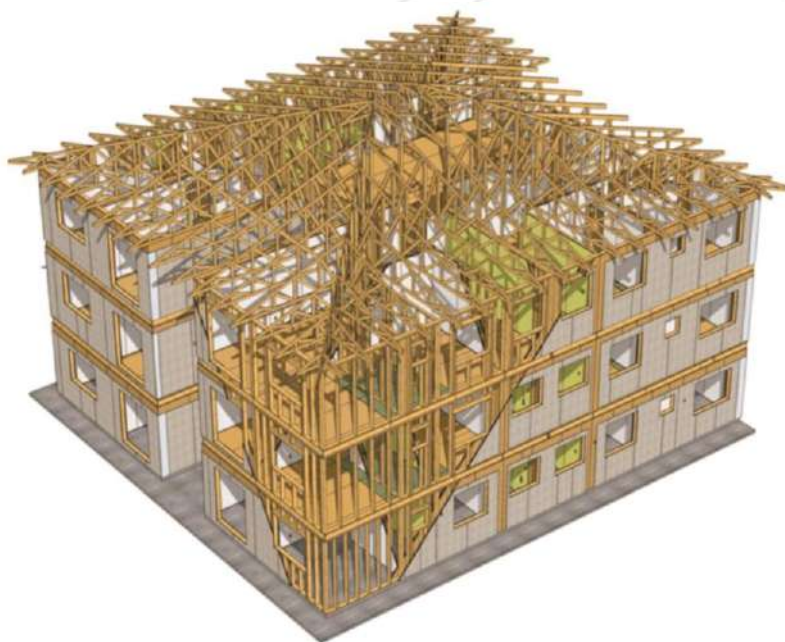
Esquema 3D do sistema construtivo Wood Frame aplicado em edifícios de até três pavimentos.
